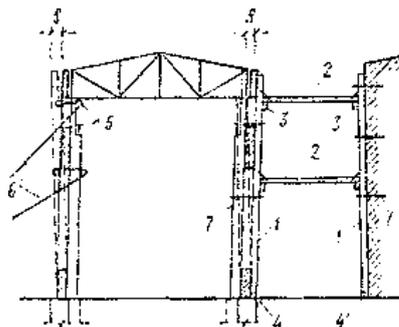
Крепление наклонившейся стены к стенам устойчивых зданий или сооружений с помощью распорок
